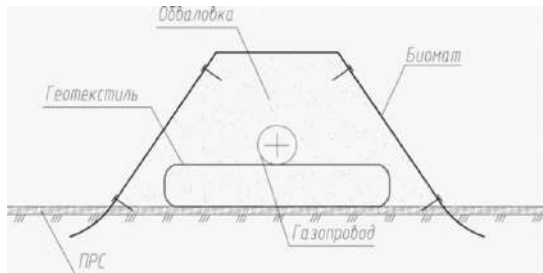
Защита биоматами грунтов обваловок газопроводов наземной прокладки, не армированных геотекстильными материалами
